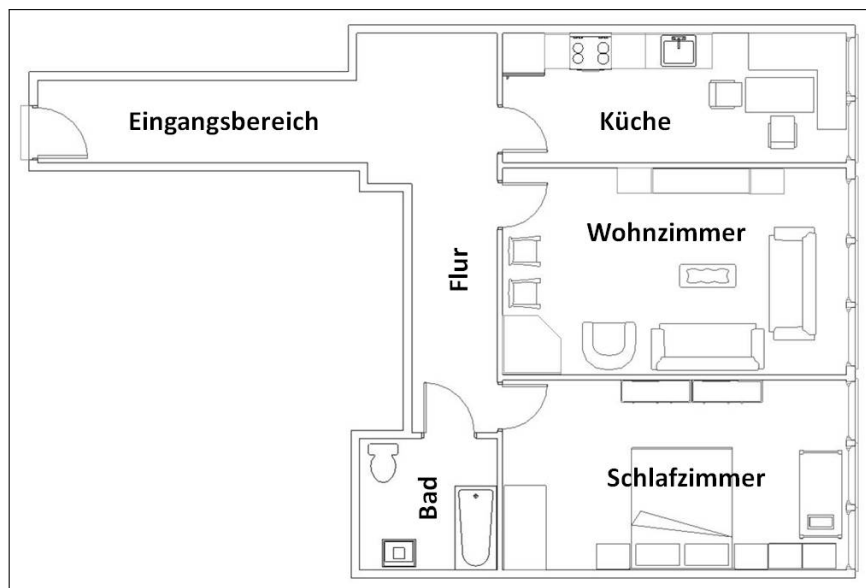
Grundriss des Versuchsobjektes (©REICHARD 2013)
